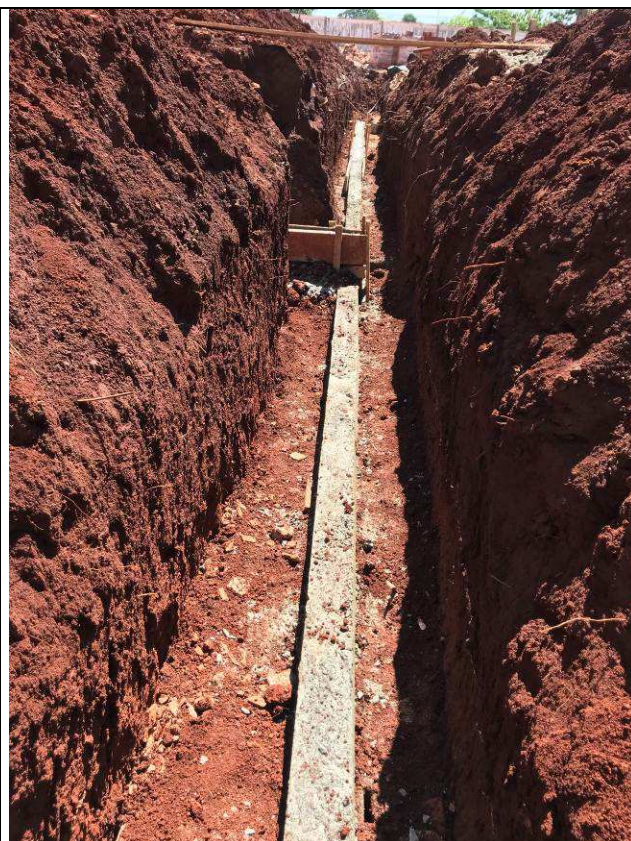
C: Tubulação da rede de hidrantes - envelopamento com concreto.
